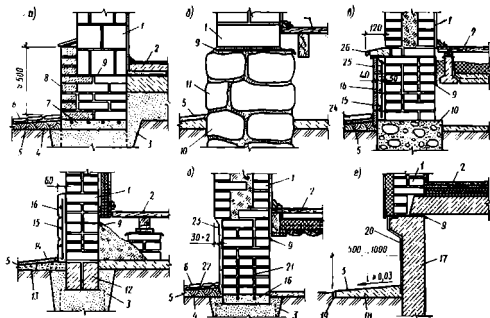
Цоколи каменных стен малоэтажных зданий:
